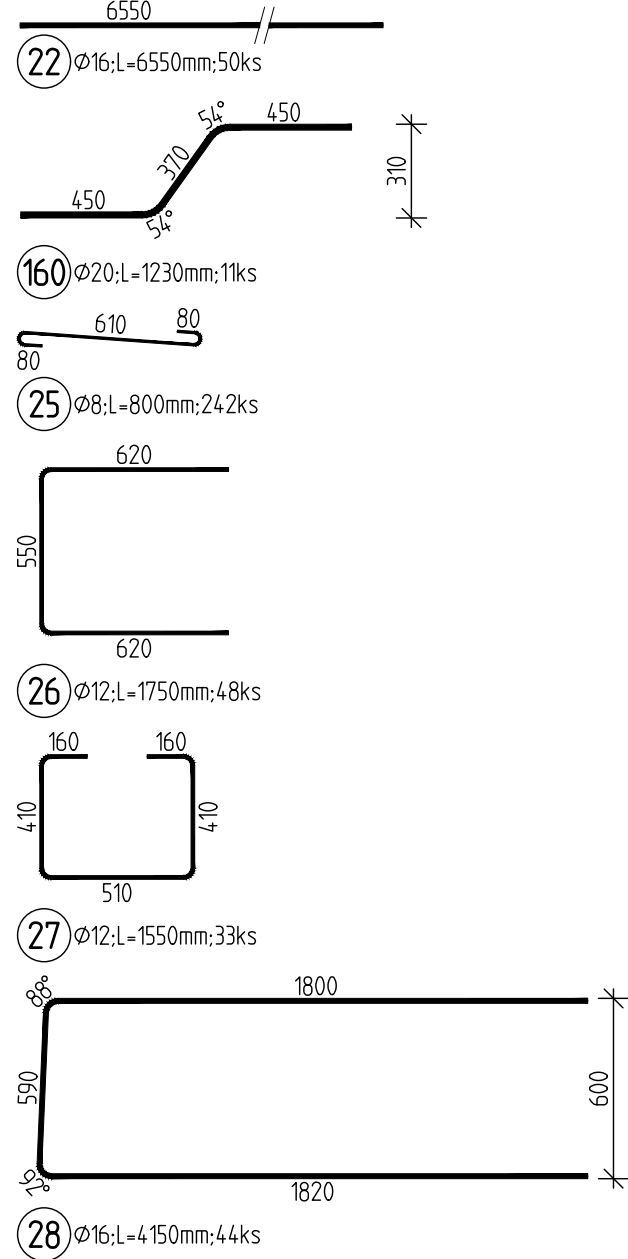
DETAIL DOPLNĚNÍ VÝZTUŽE V MÍSTĚ
